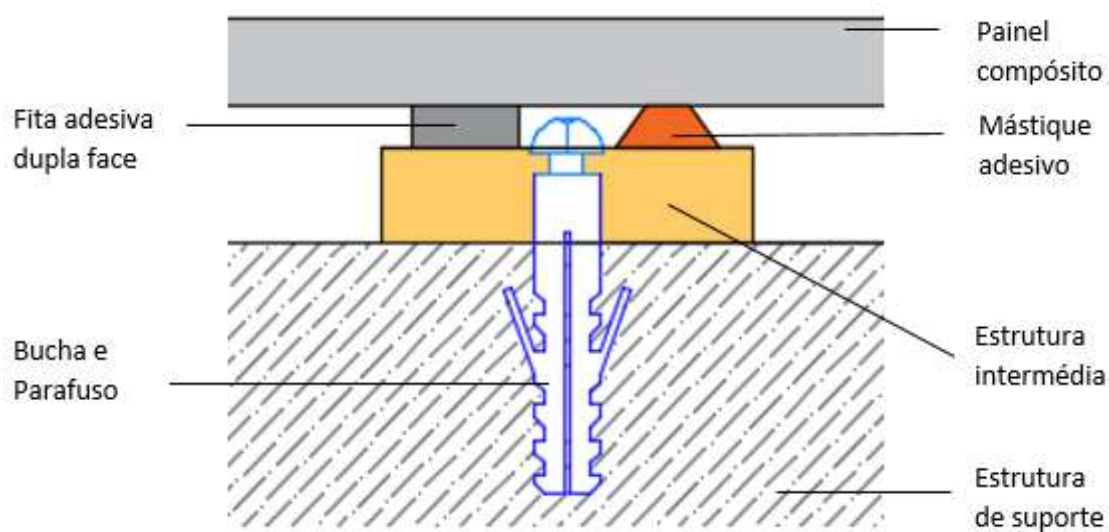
Pormenor construtivo na aplicação em pavimentos
